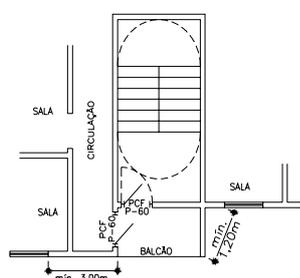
Escada enclausurada do tipo PF ventilada por balcão
